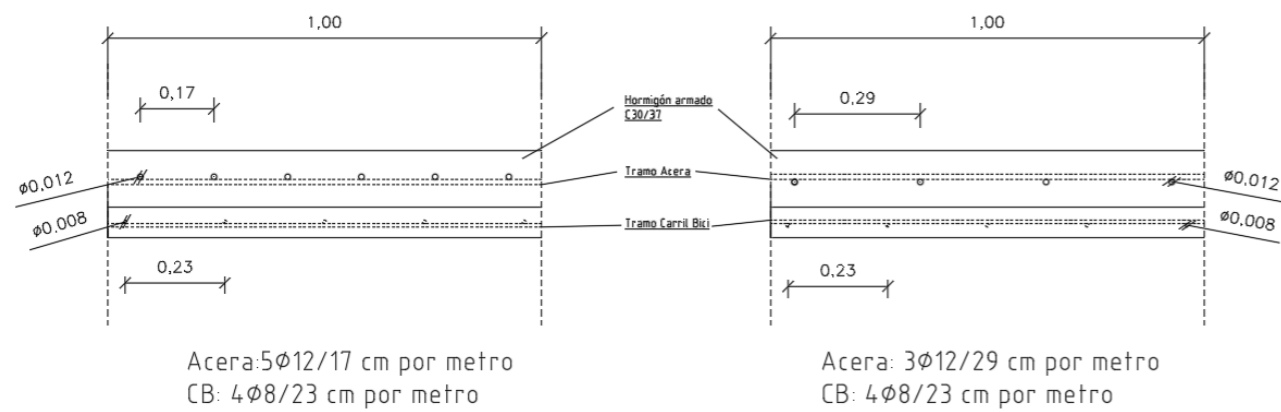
Detalle de armado de la losa superior del tablero. Fuente: Elaboración Propia (AutoCAD)
